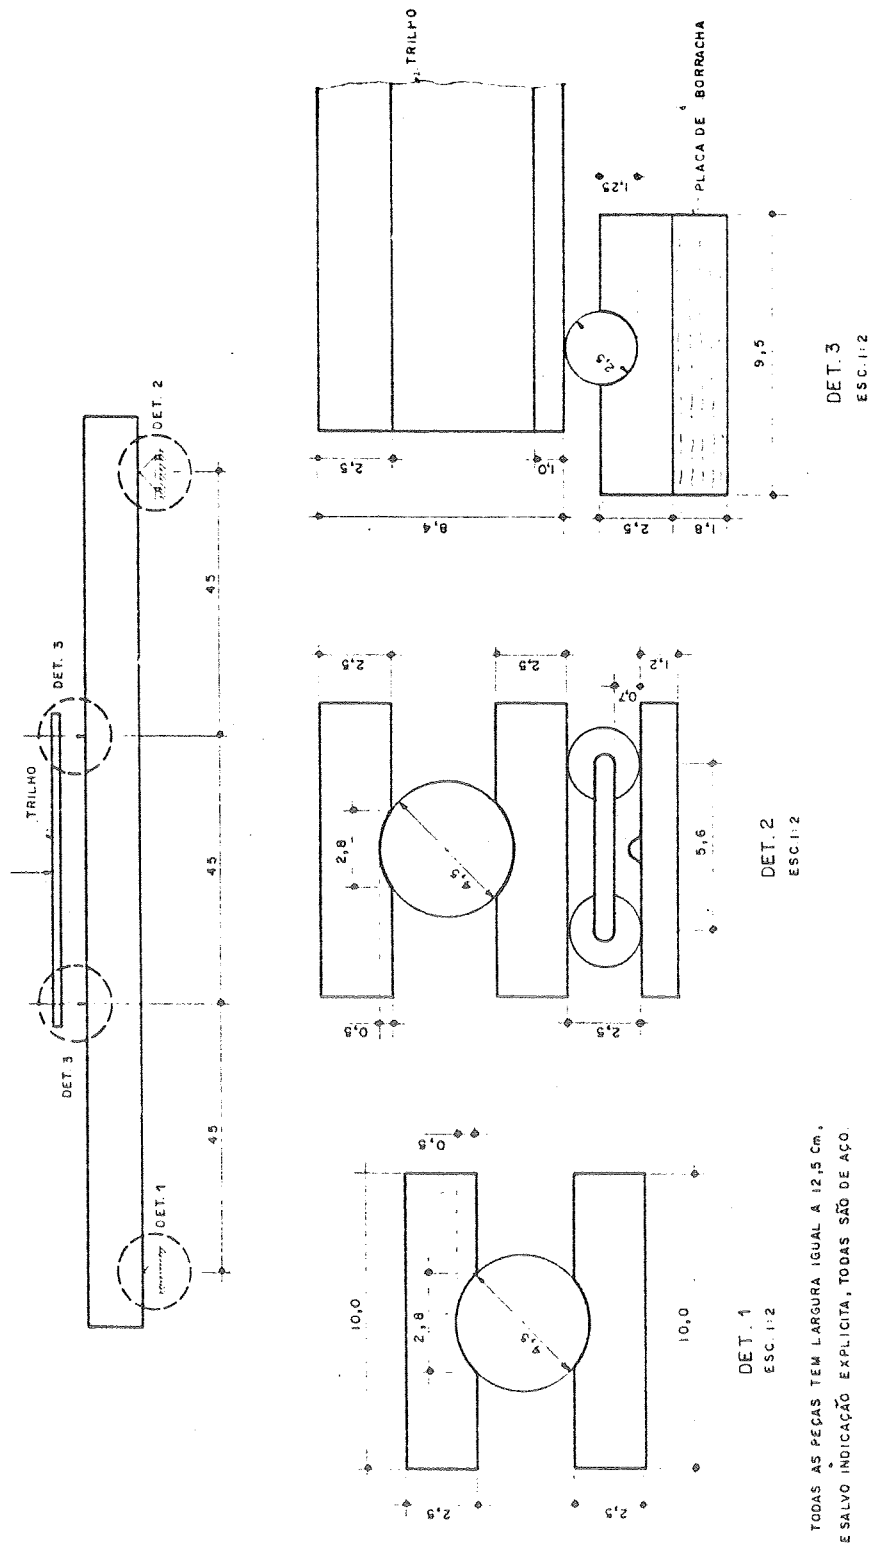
Características das Vigas Ensaçadas-Dispositivos de Apoio (MARTINELLI,1974)
